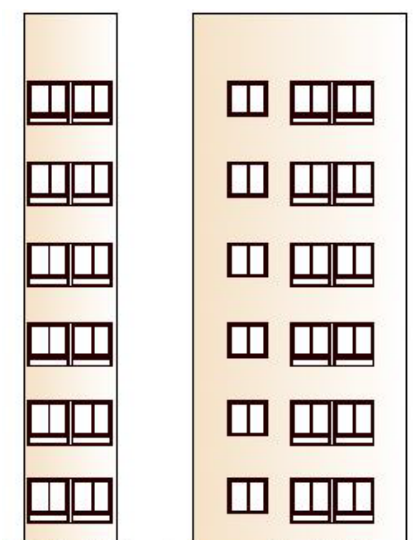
Fachadas patio de luces F4,F5. [Anexo II. Planos]
